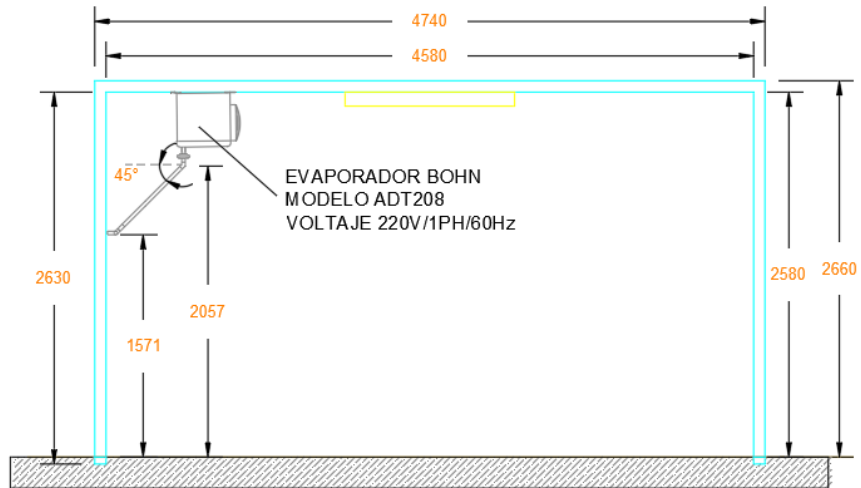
Cámara de refrigeración - Corte A-A (Vista de elevación)
